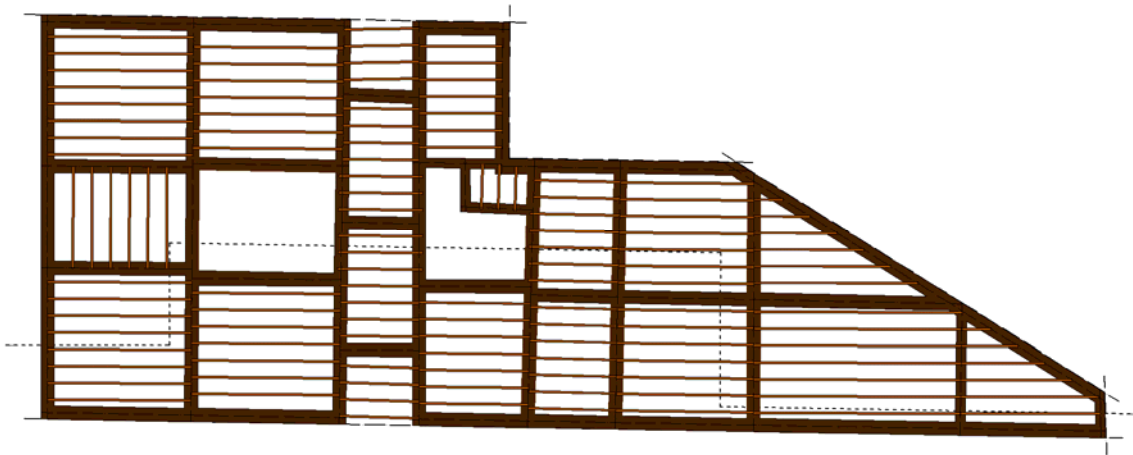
Forjado de planta 1ª. Fuente propia.
